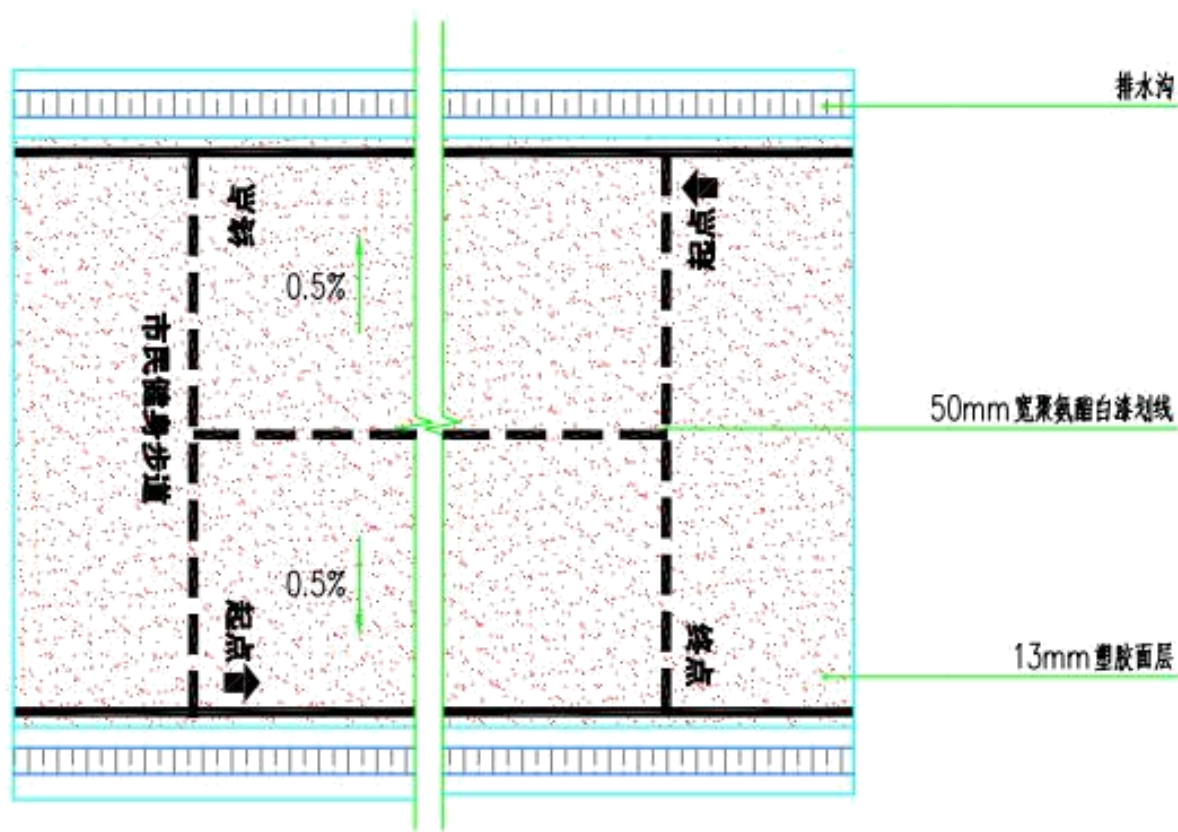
透水沥青混凝土健身步道参考剖面图 (单向)
